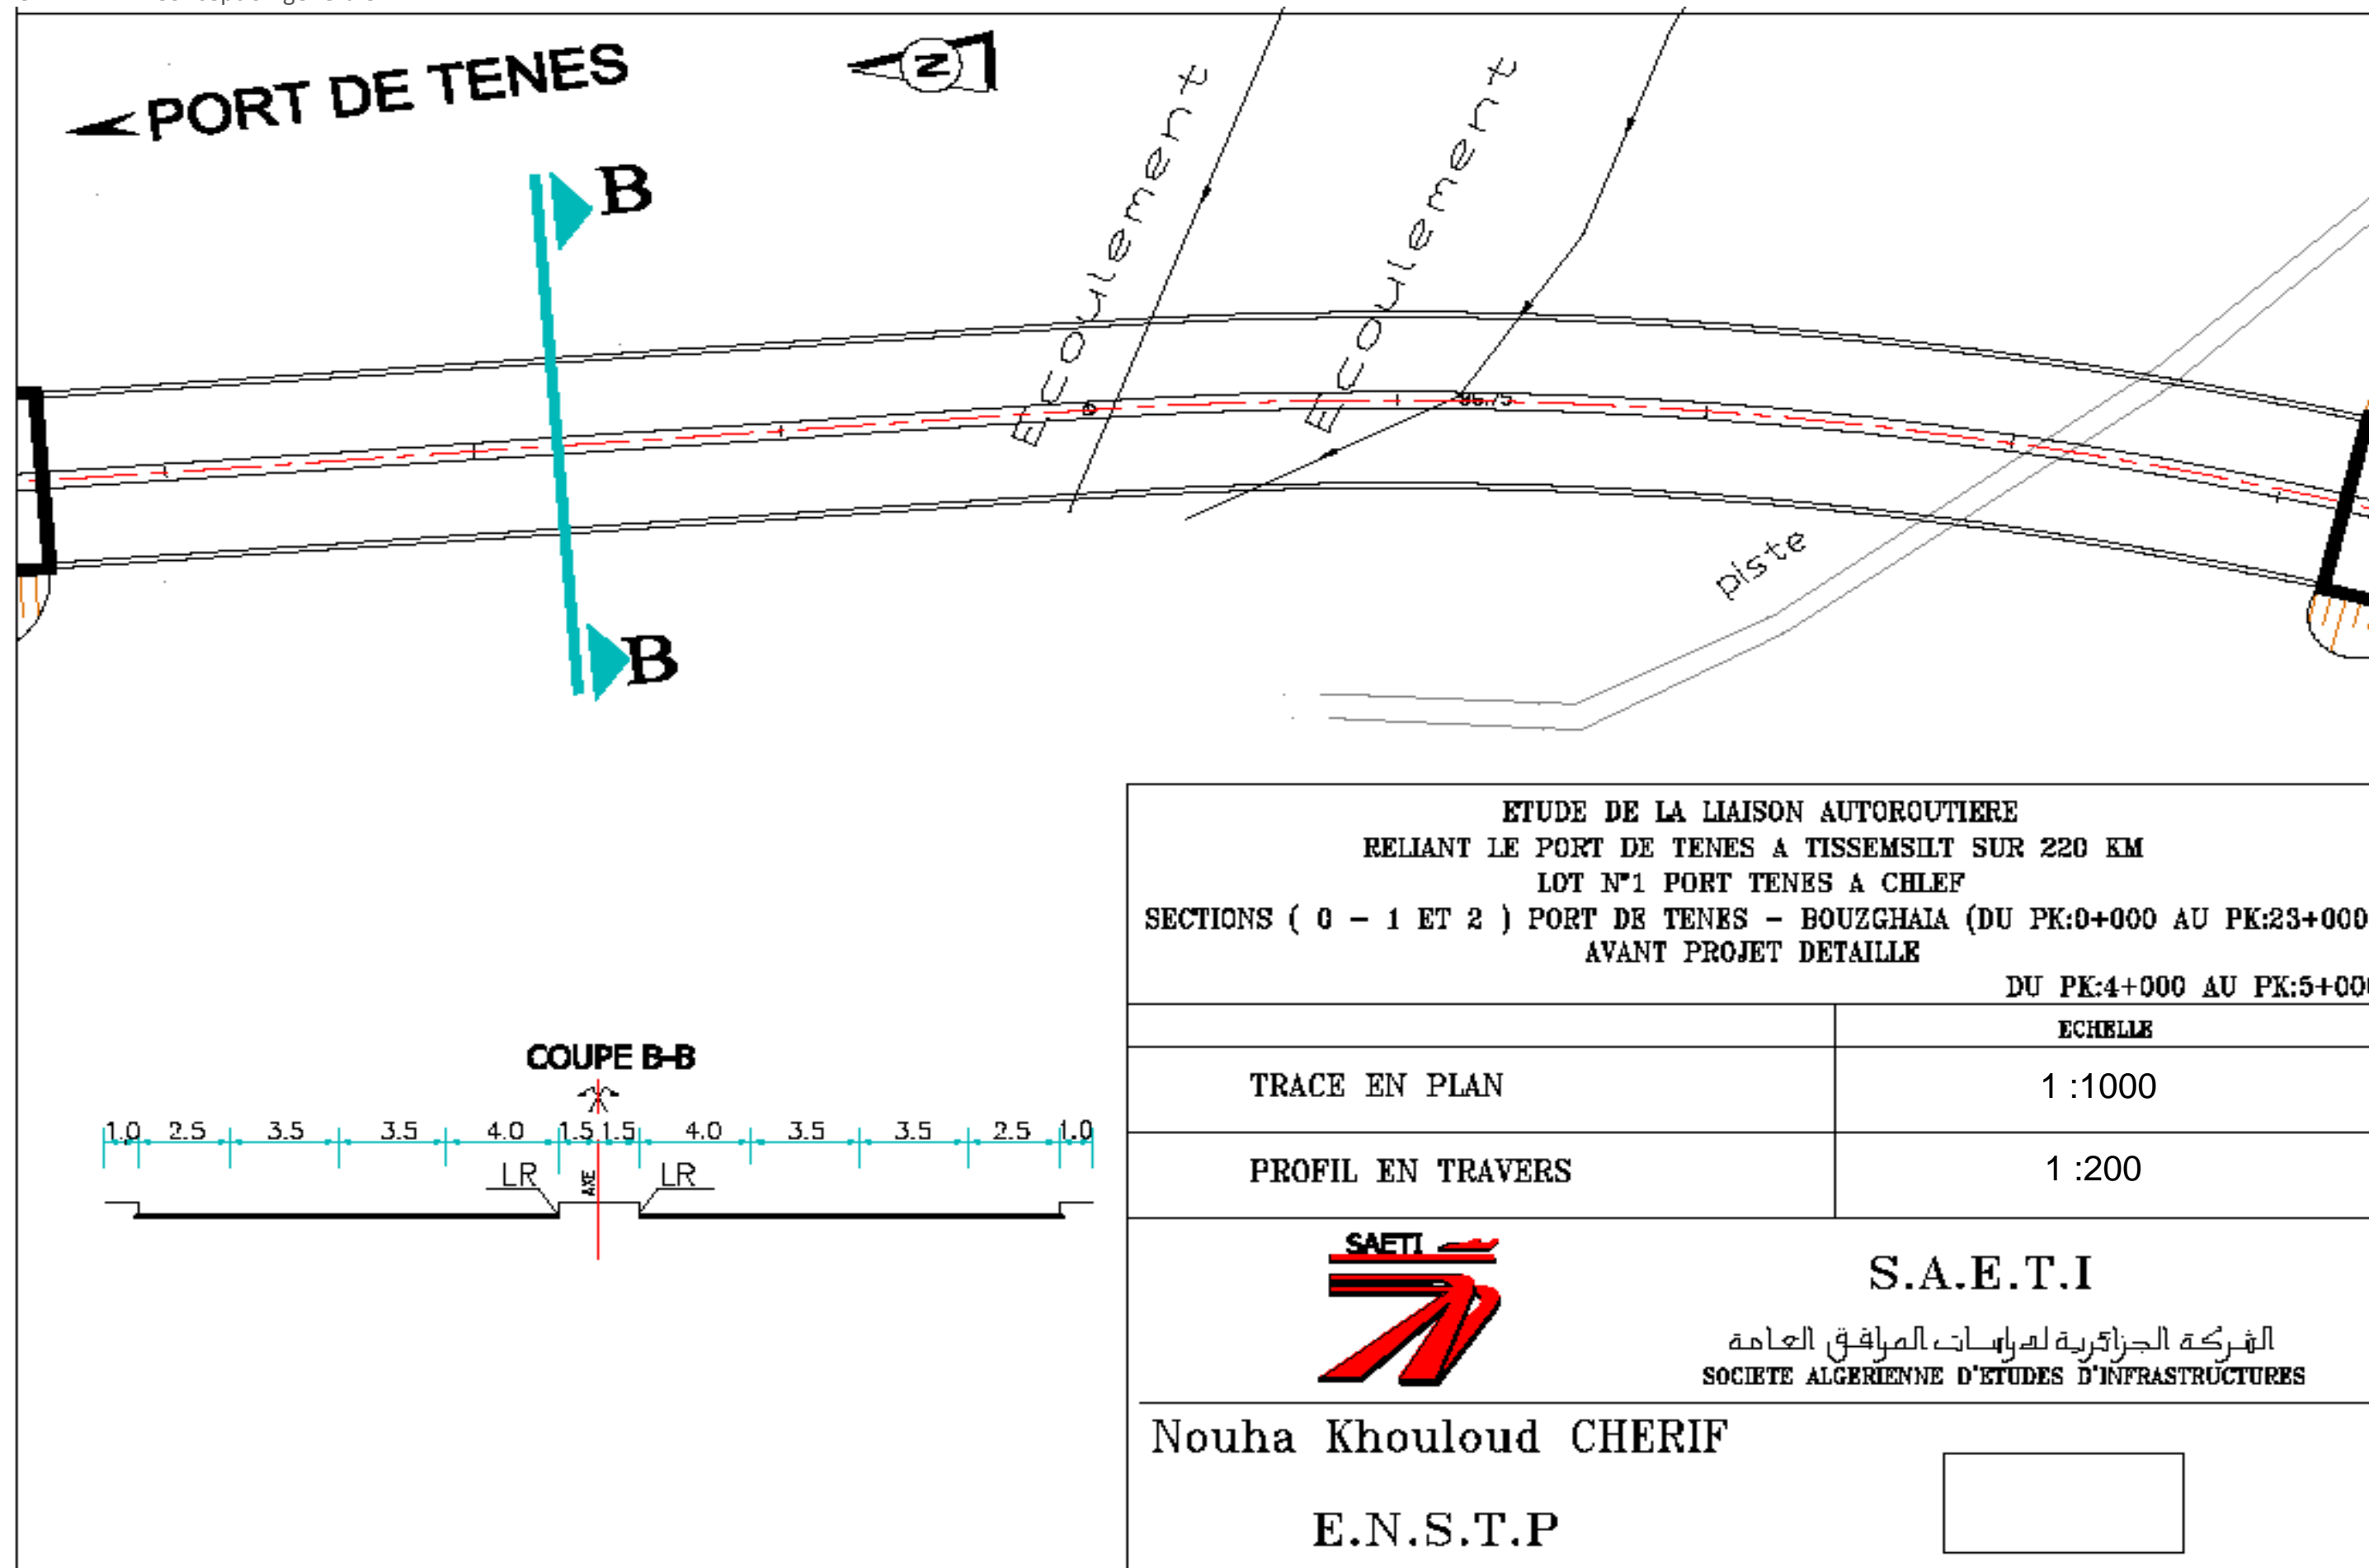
Tracé en plan et profil en travers de l'ouvrage de franchissement
